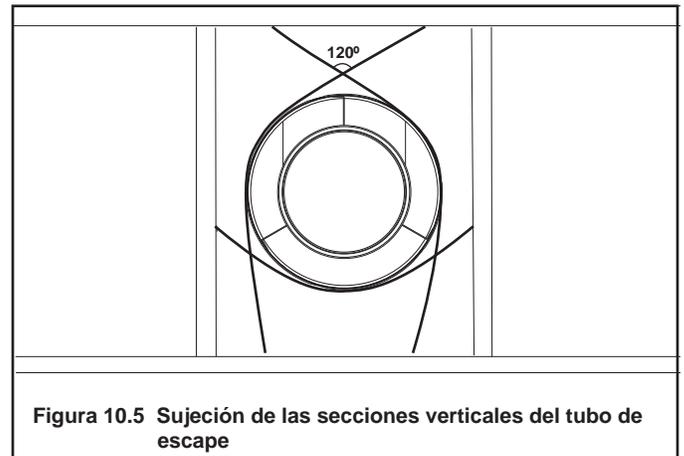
Sujeción de las secciones verticales del tubo de escape
